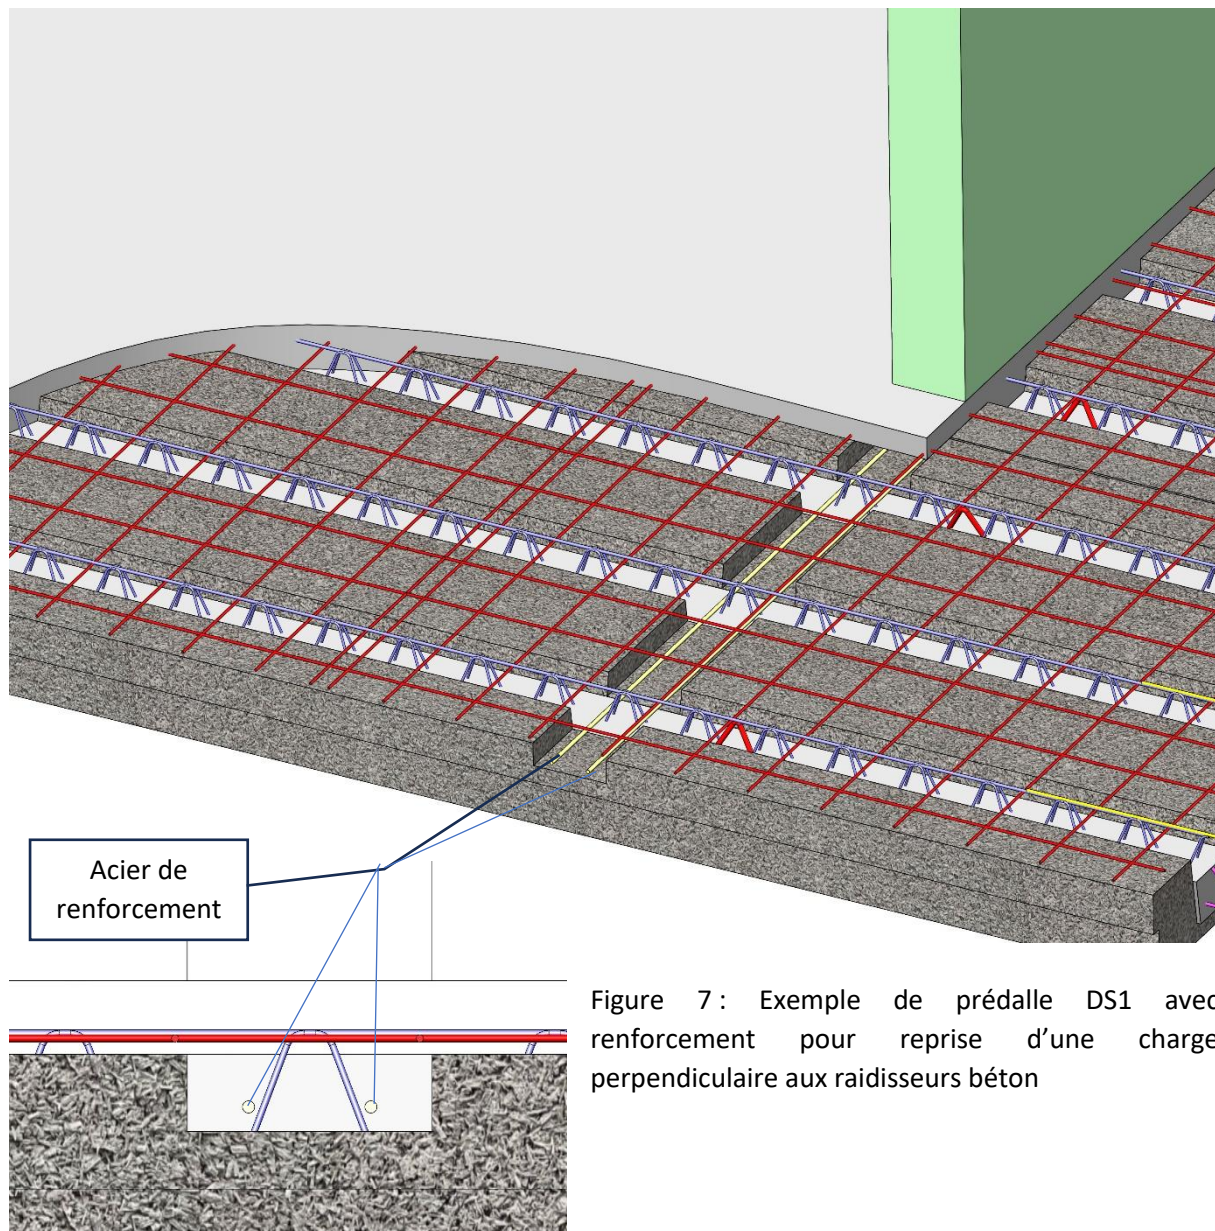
Exemple de prédalle DS1 avec renforcement pour reprise d'une charge perpendiculaire aux raidisseurs béton
